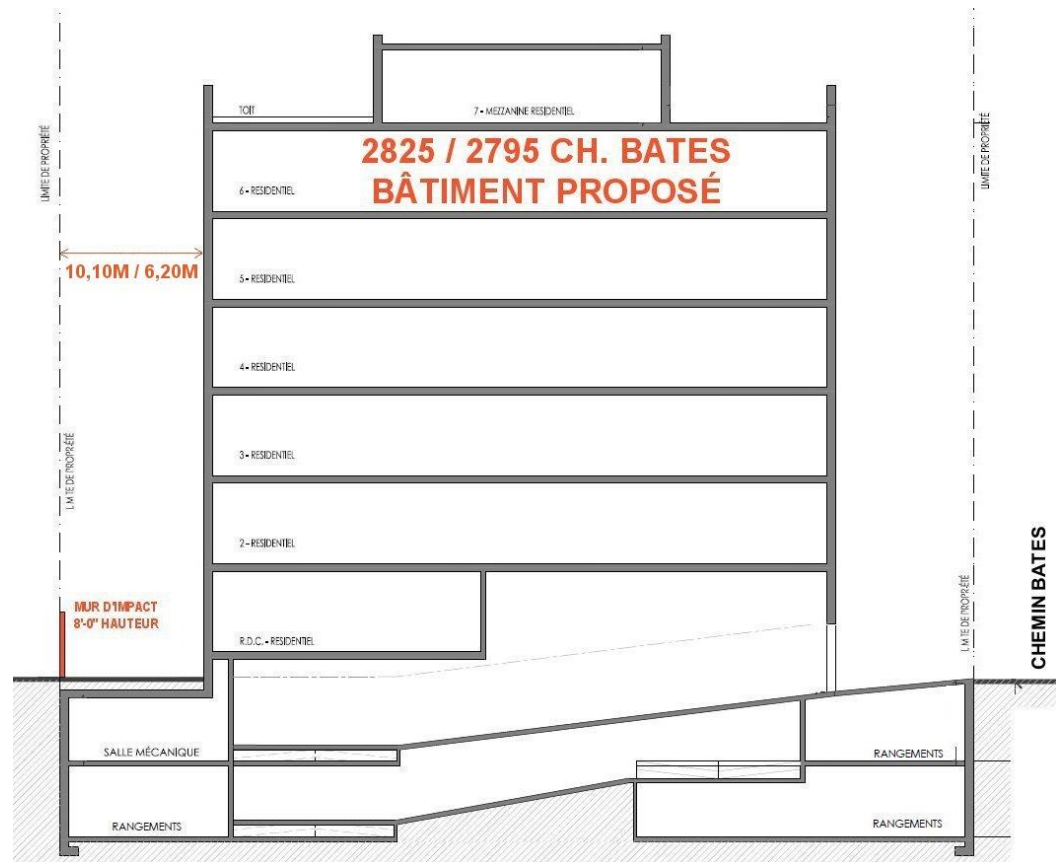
Mur d'impact de 2,44 mètres (8'-0") min. de hauteur en béton armé.
